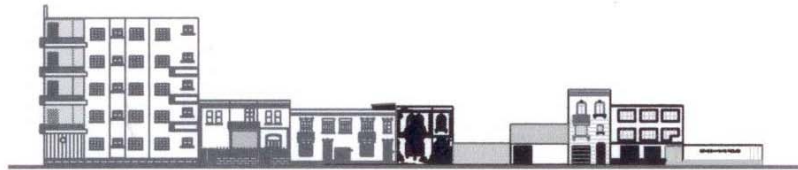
Perfil urbano de la Calle de Colima, entre Jalapa y Orizaba
